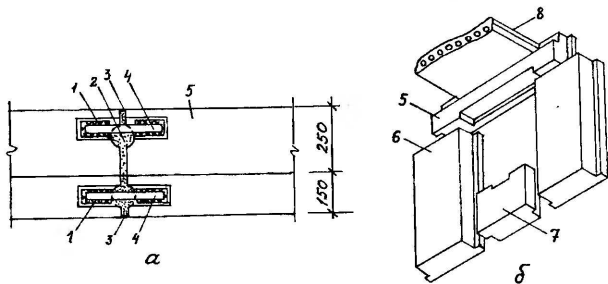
Стыки элементов крупноблочных зданий: а – стык перемычечных (поясных) блоков; б – стык плит перекрытий с перемычечными (поясными) блоками; 1 – сварной шов; 2 – раствор; 3 – расшивка раствором; 4 – закладные детали и связи; 5 – перемычечные (поясные) блоки; 6 – простеночный блок; 7 – подоконный блок; 8 – плита перекрытия
